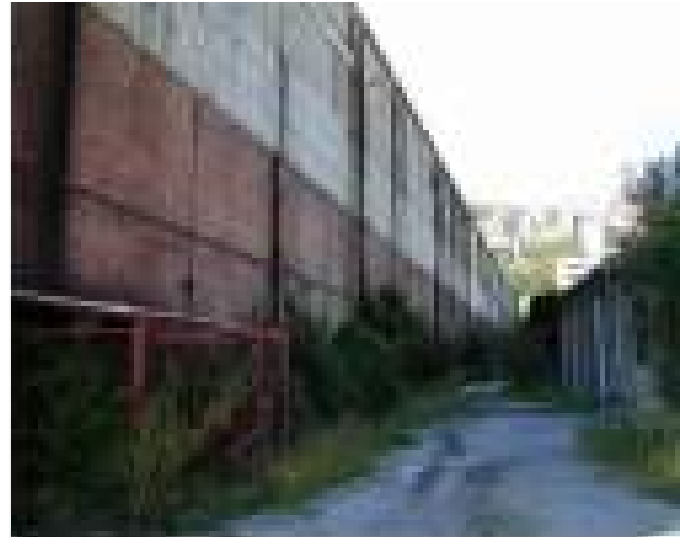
IL PERIMETRO VERSO IL "MURO" DELLE SERRE DI PRA'
